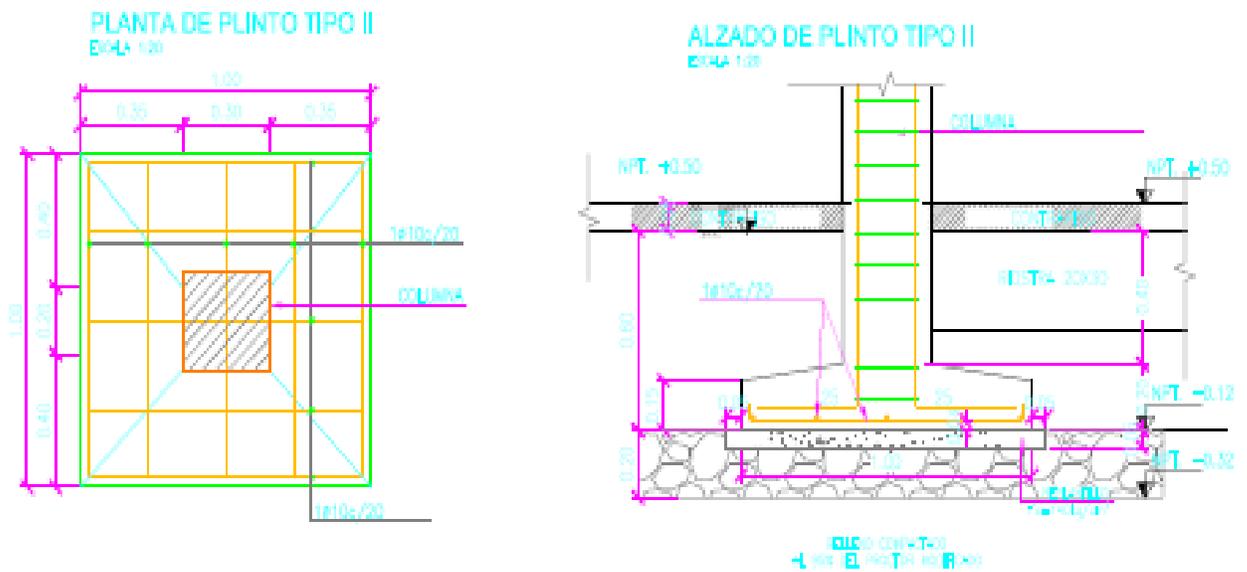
; Detalle de plinto 1,20 X 1,20 m para diseño de hormigón armado
